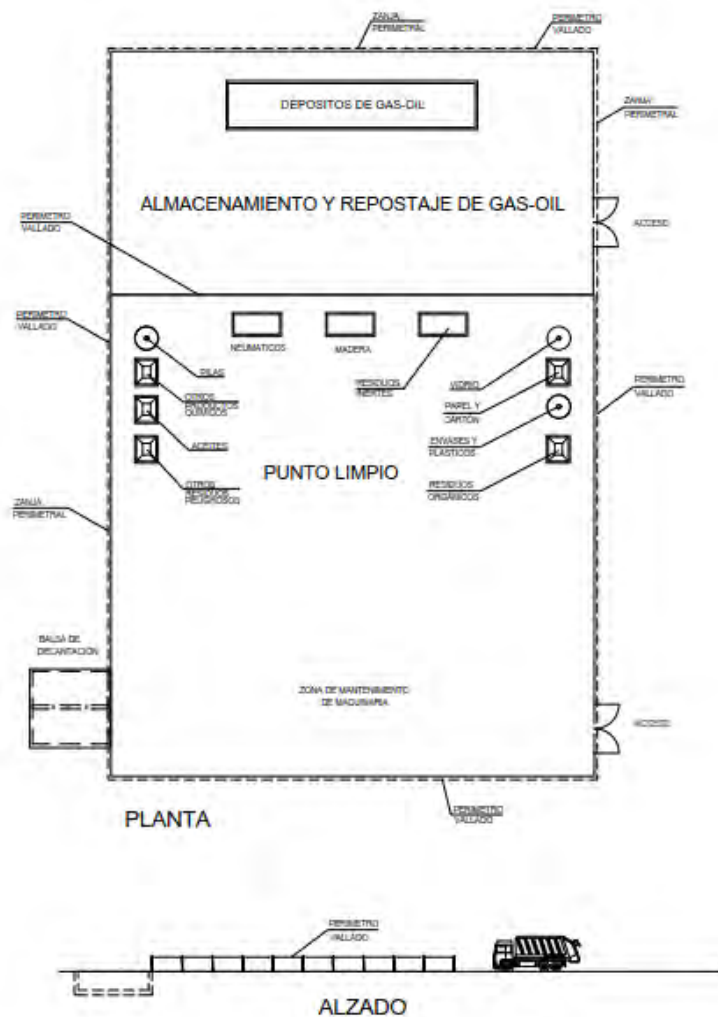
Detalle zonificación instalación auxiliar de obra
